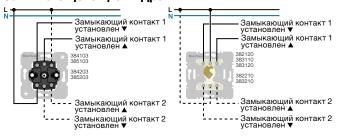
Жалюзийный поворотный выключатель 1- и 2-полюсный [№ для заказа 3841 03, 3842 03]; выключатель жалюзи 1- и 2-полюсный для центральной панели с замком [№ для заказа 3851 03, 3852 03] / выключатель/кнопка жалюзи 1- и 2-полюсный для профильных полуцилиндров [№ для заказа 382.., 383..]
